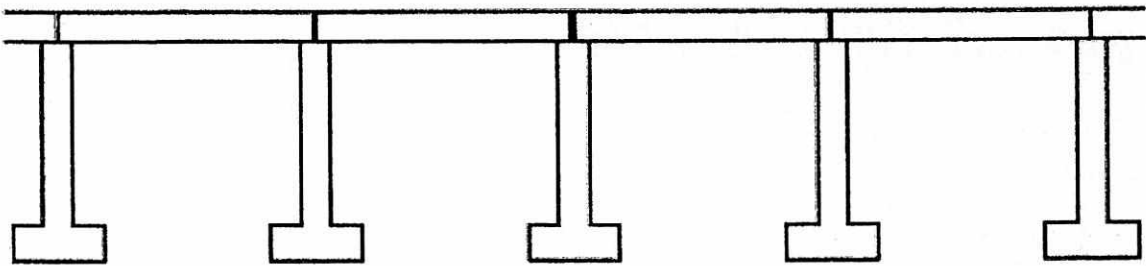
Puente de vigas doble T prefabricadas para luces moderadas.
